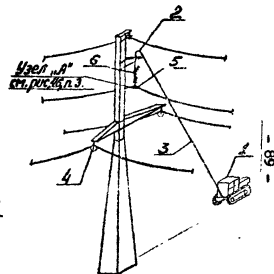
Перекладка проводов верхней траверсы с опусканием на нижнюю траверсу опоры
